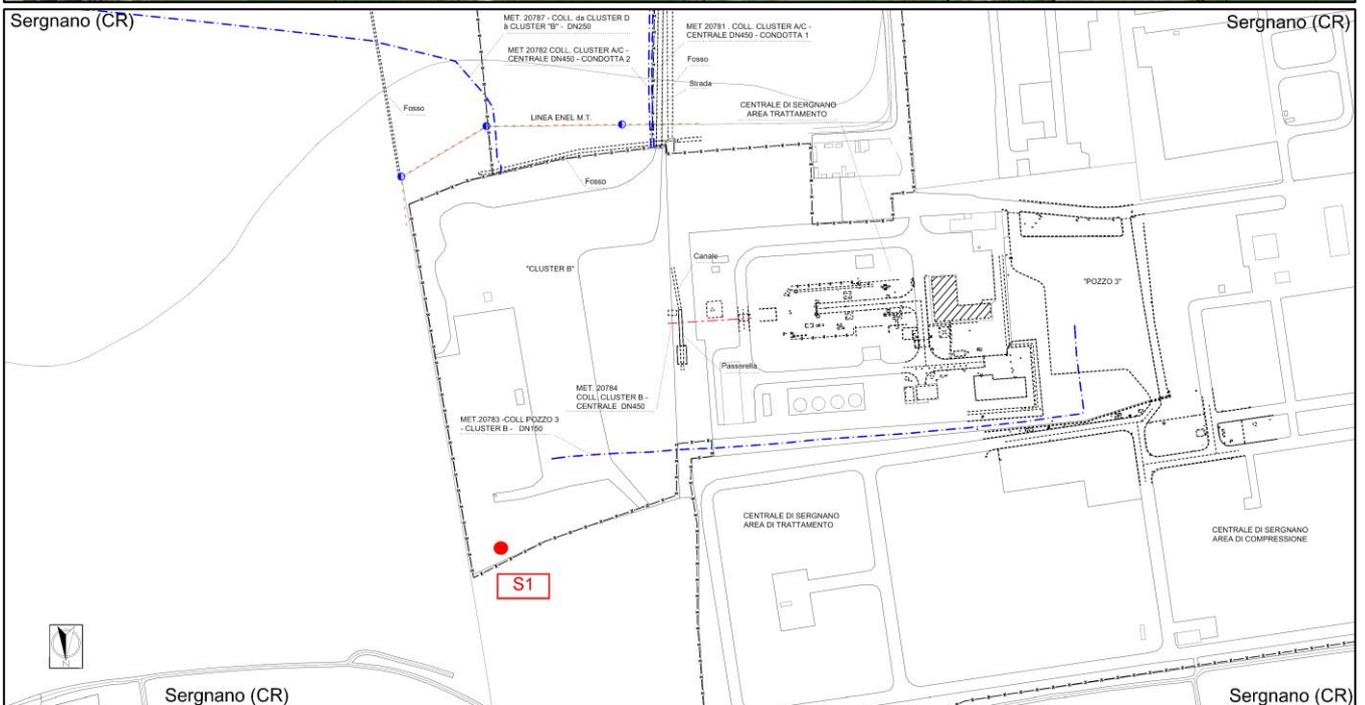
Planimetria di dettaglio ubicazione sondaggio S1
